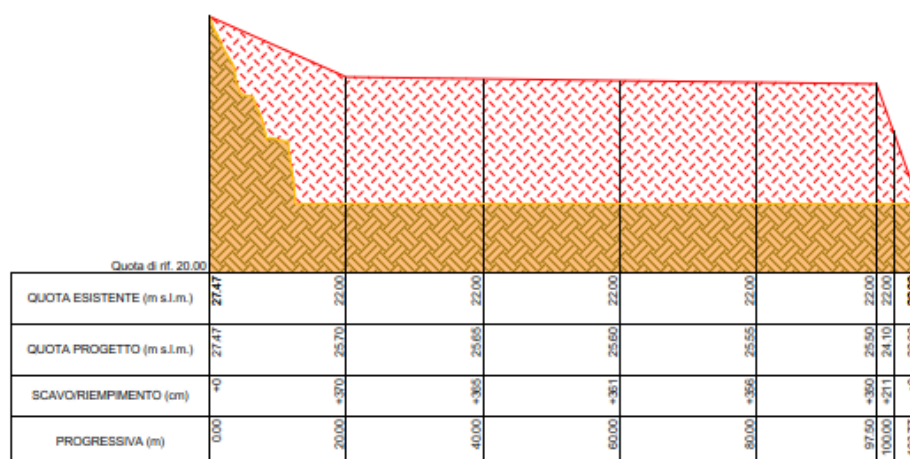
Profilo longitudinale di progetto della scogliera. Estratto della tavola PF.0.2.7.PRG.GE.S.Z.0.0.1.A.
